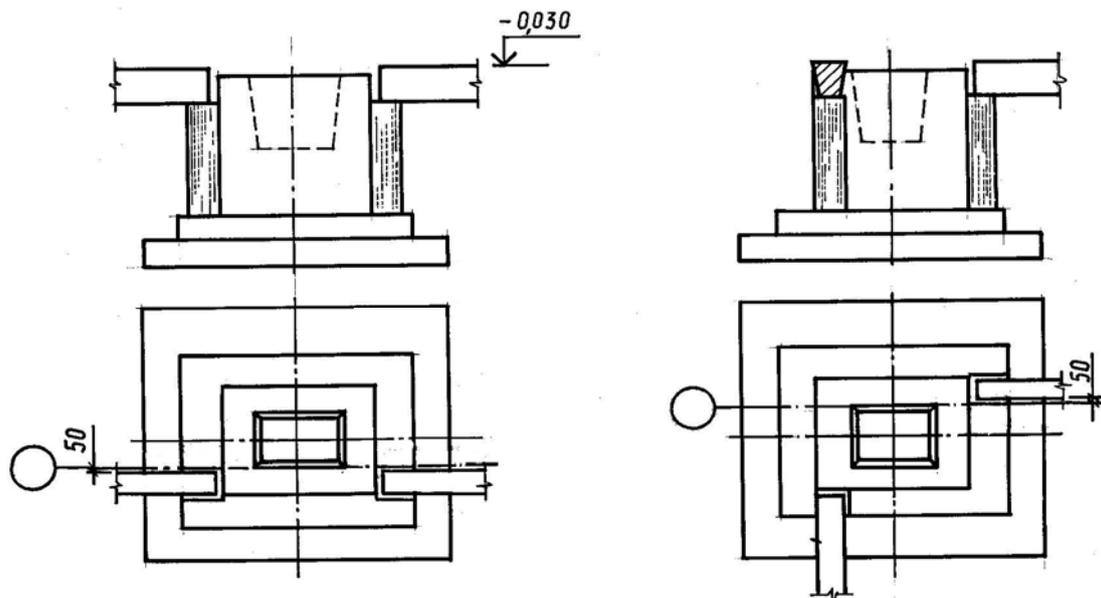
Фундаменты с бетонными столбиками для опирания фундаментных балок
